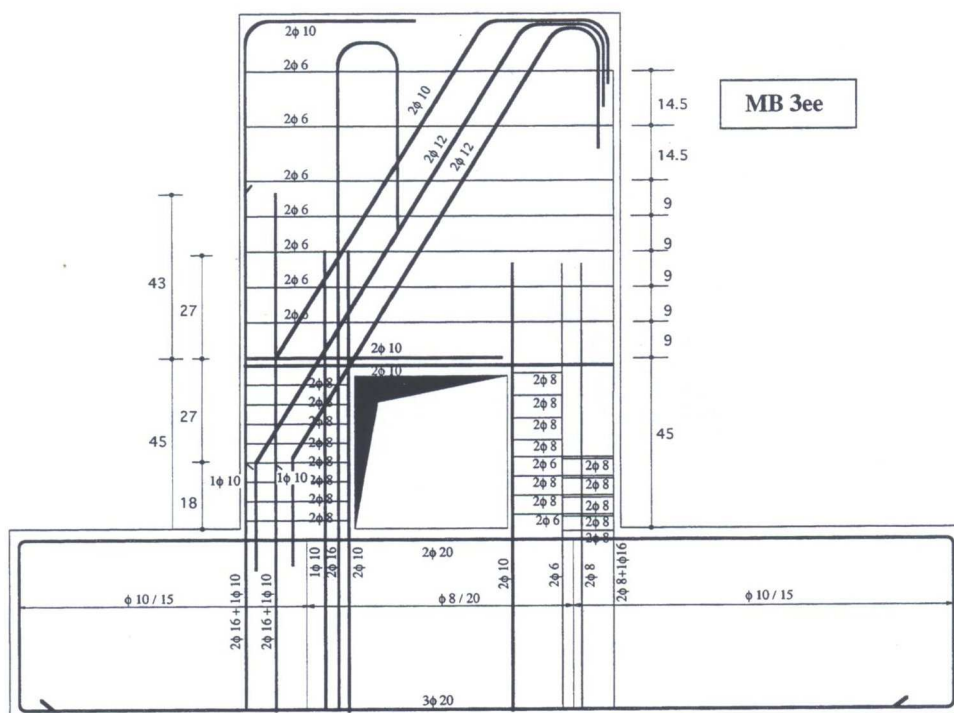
Pormenorização das armaduras do modelo MB3ee-EXP, adaptado [10]
